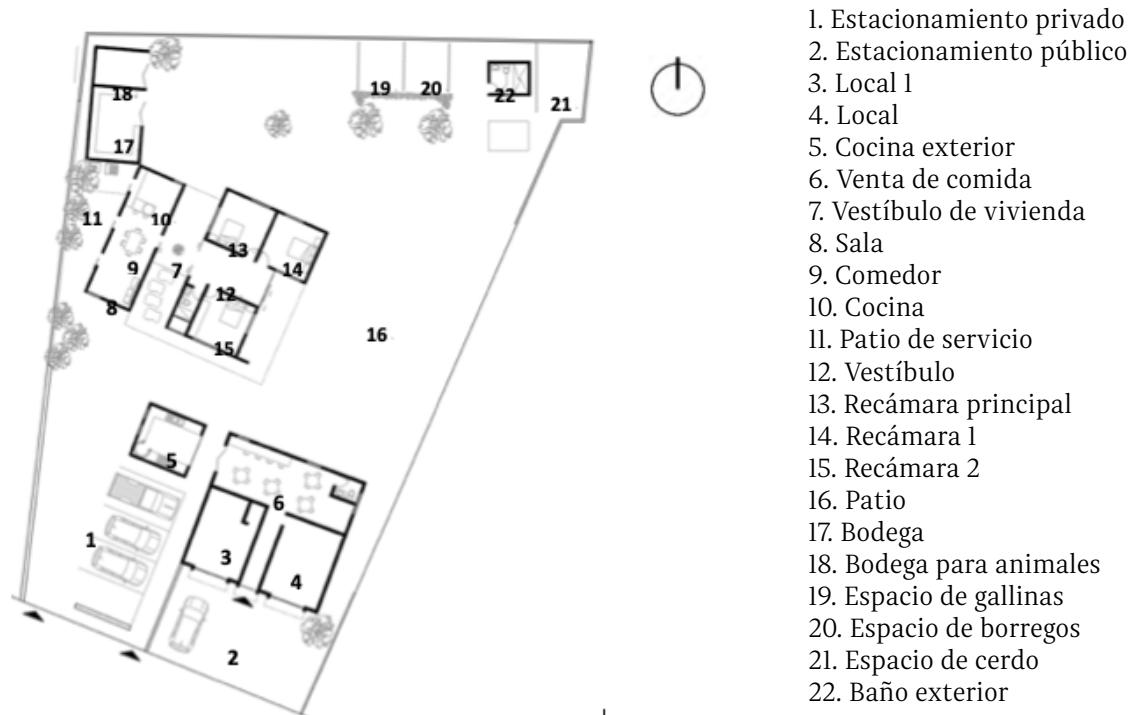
Planta arquitectónica de propuesta de vivienda. NOTA: elaboración propia.
